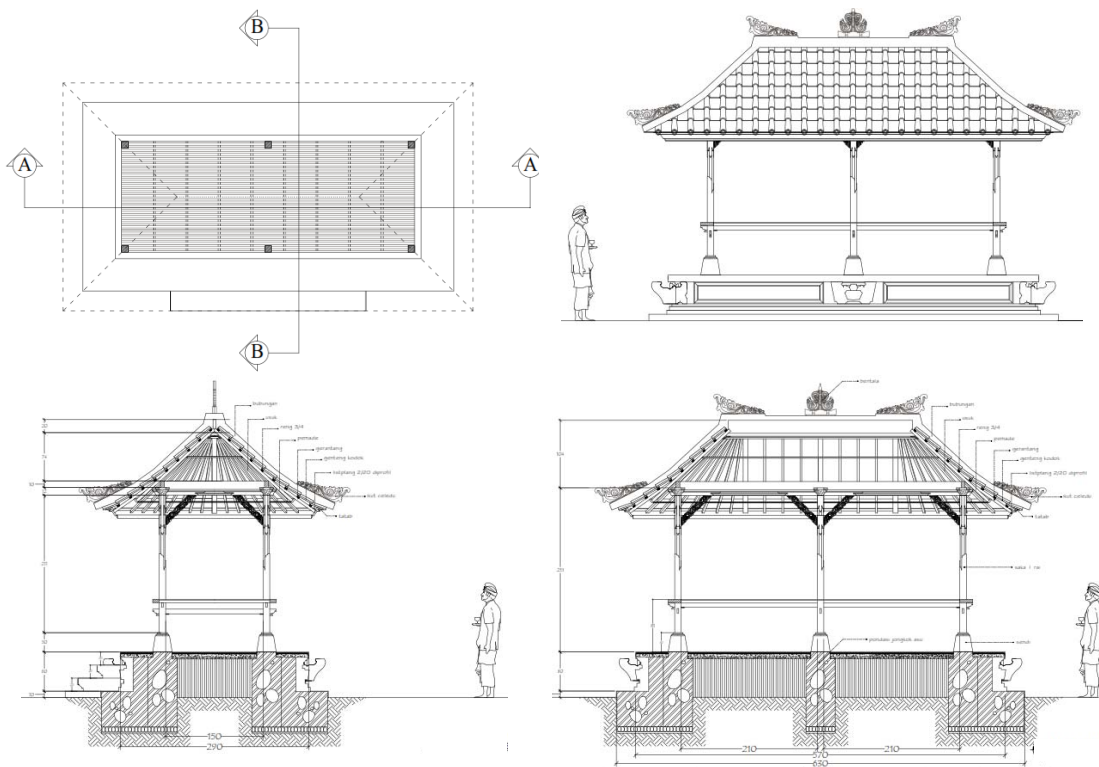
Denah dan Tampak *Pelingih* Anglurah
